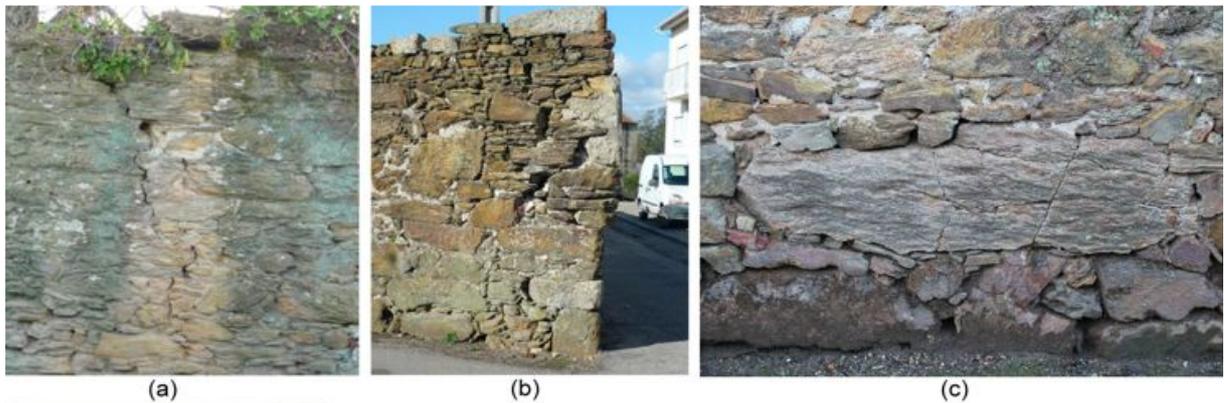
(a) Fissuras e fendas provocadas em muro por deformação no plano (CA); (b) Fratura provocada por deformação de cunhal (PR); (c) Esmagamento provocado por sobrecarga e deformação de muro (TR)
